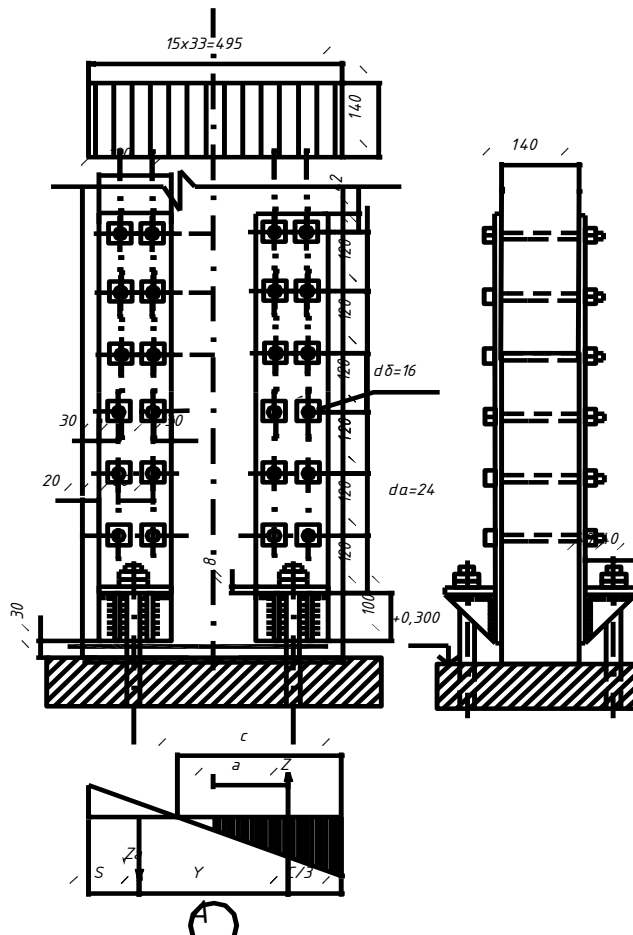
Опорний вузол колони з 12 двозрізними болтами
